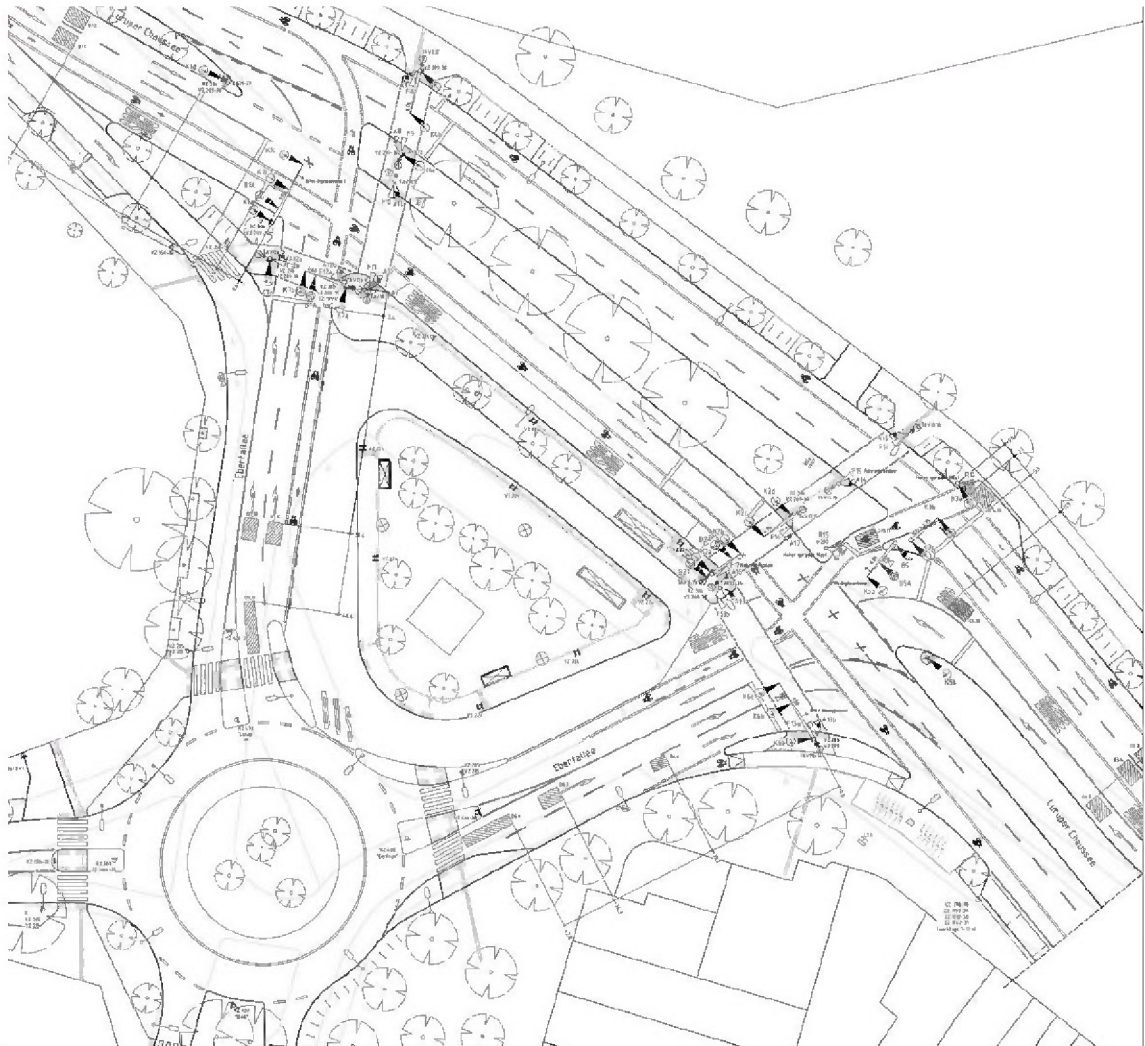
Signallageplan Luruper Chaussee/Ebertplatz – Bestand (17/450-04-05/02) [13]
